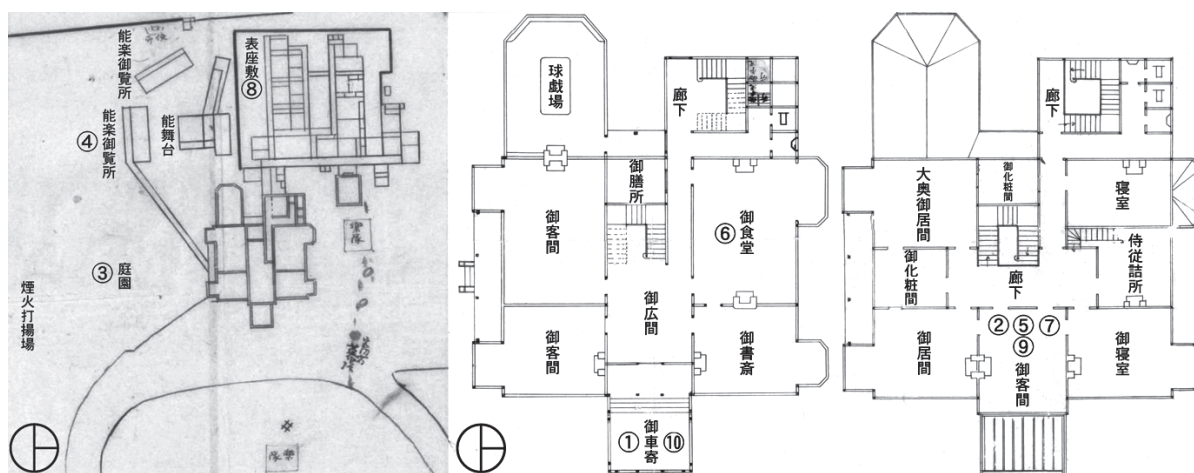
池田章政郎 配置図・洋館一階平面図・洋館二階平面図(室名・番号筆者加筆)<sup>(29)</sup>
